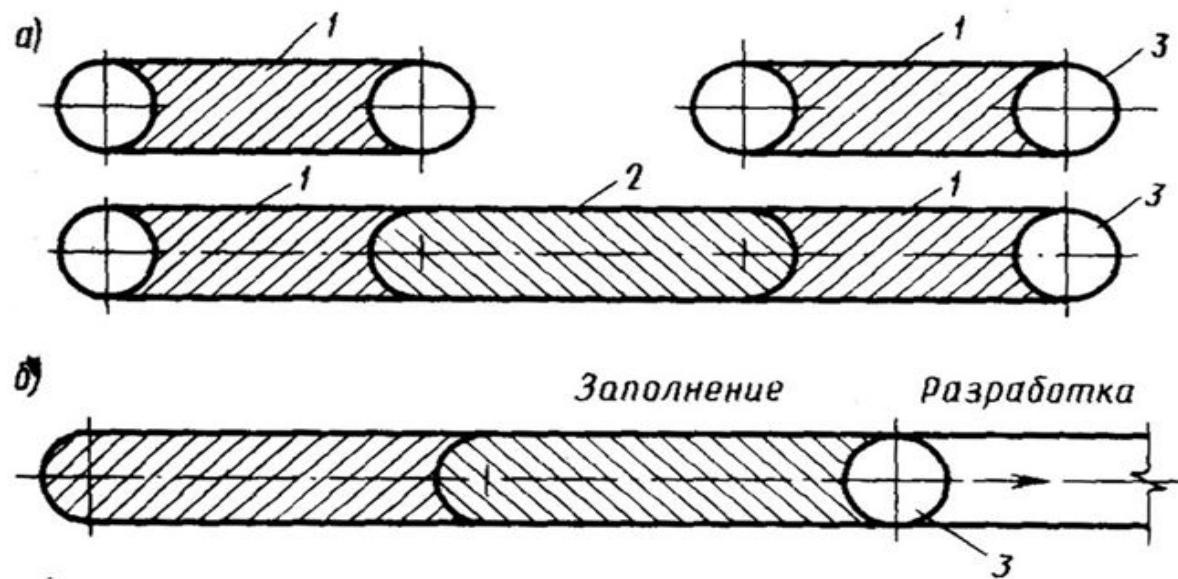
Виды траншейных и свайных стен, выполненных в грунте
